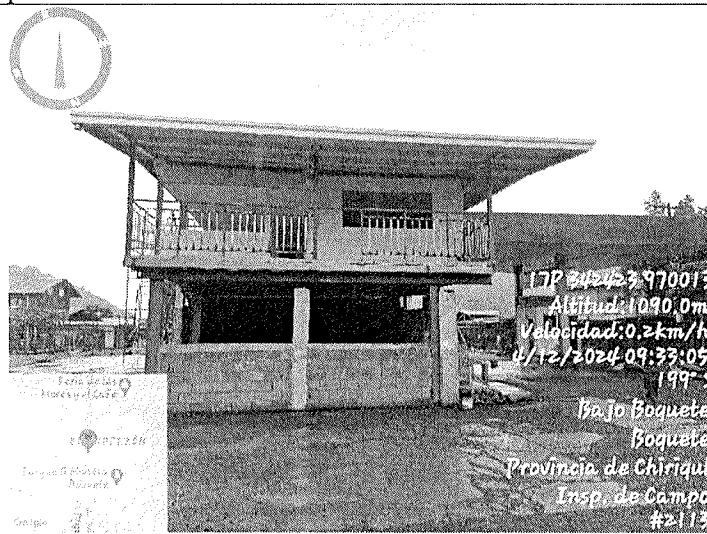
Vista parcial de las estructuras existentes y en construcción.
